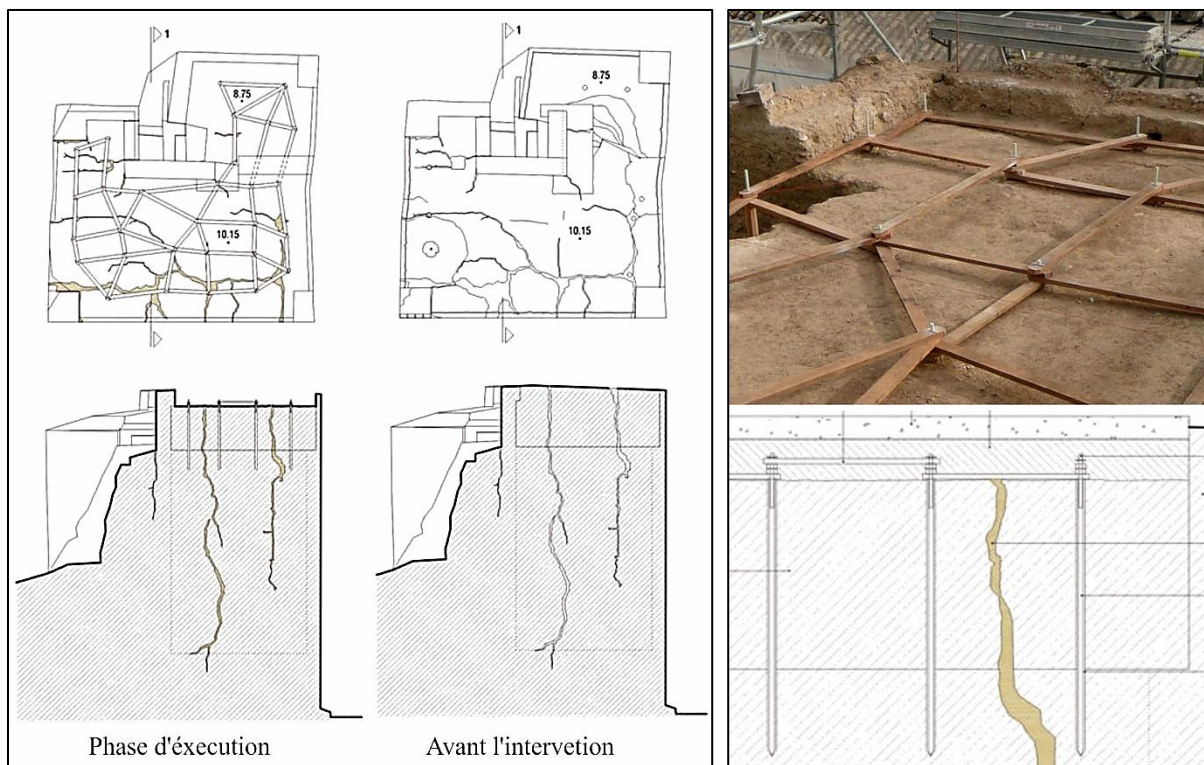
Détails techniques de couture de fissure sur les parements et en terrasse. Source José Manuel LOPEZ
